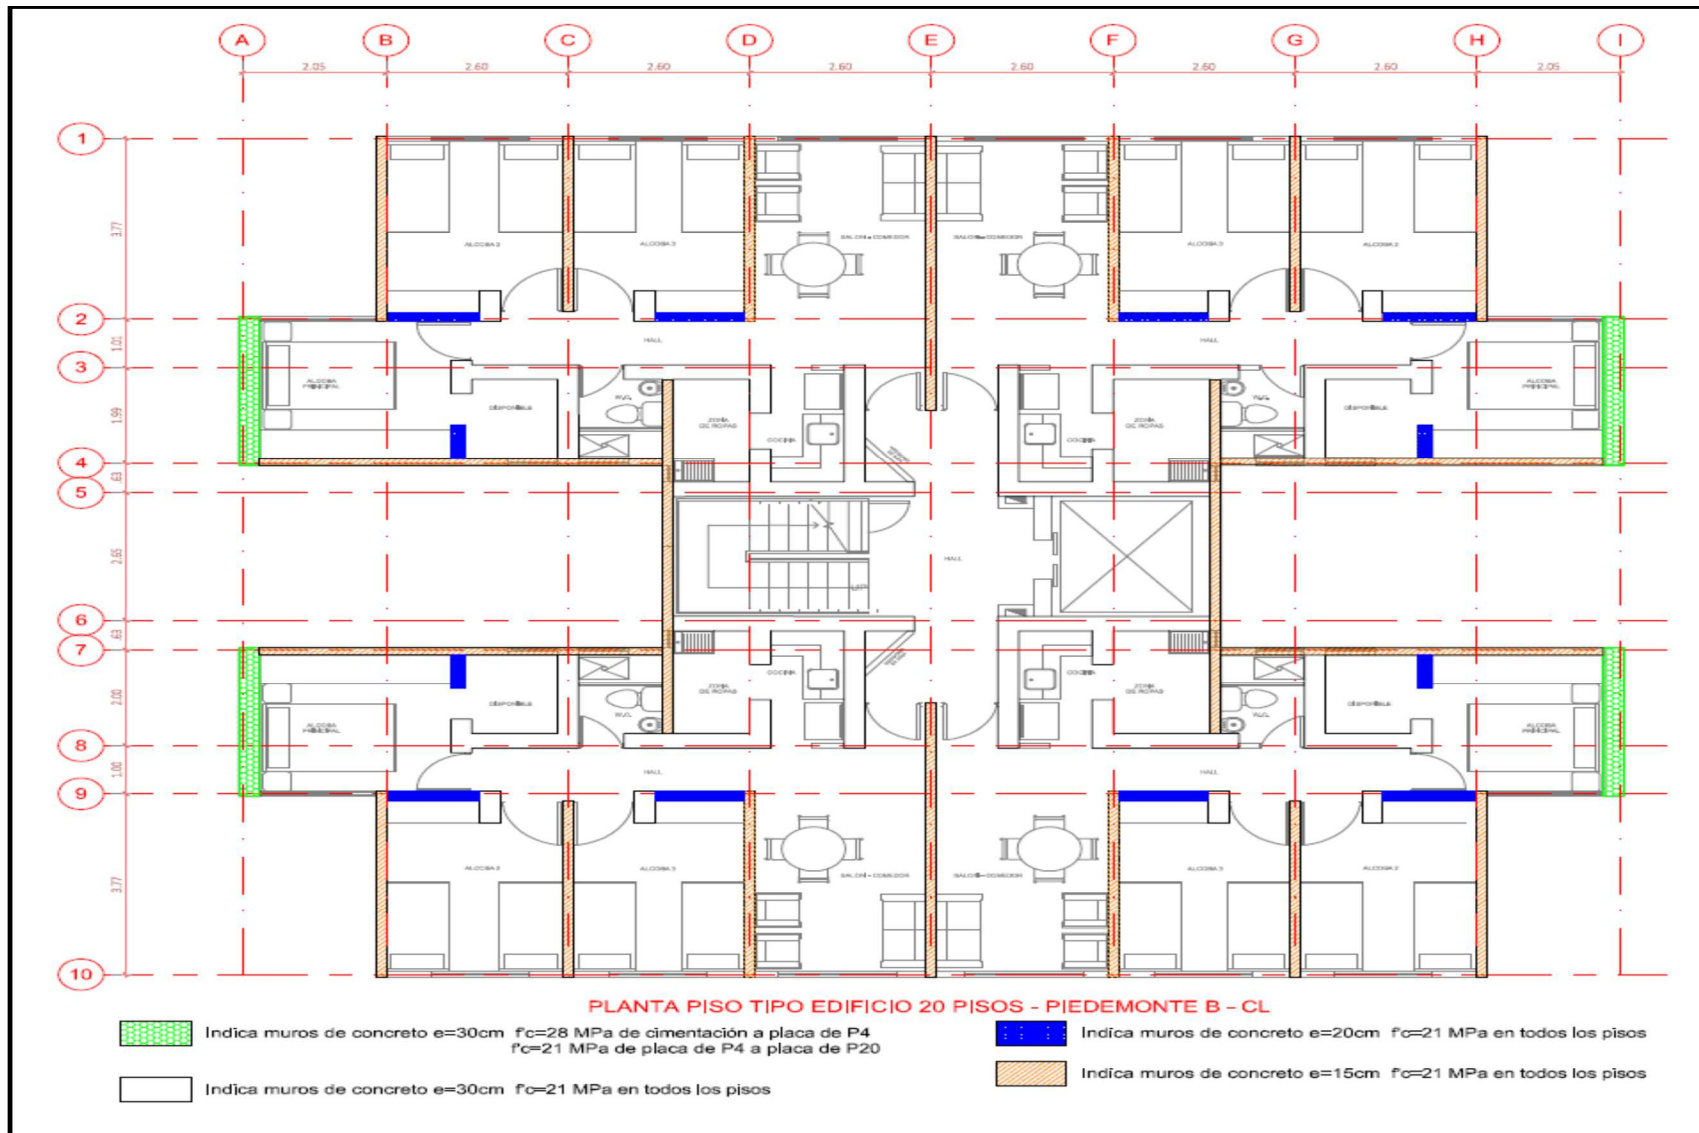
Planta piso tipo edificio de veinte pisos – Piedemonte B-CL. Elaborada por la autora
